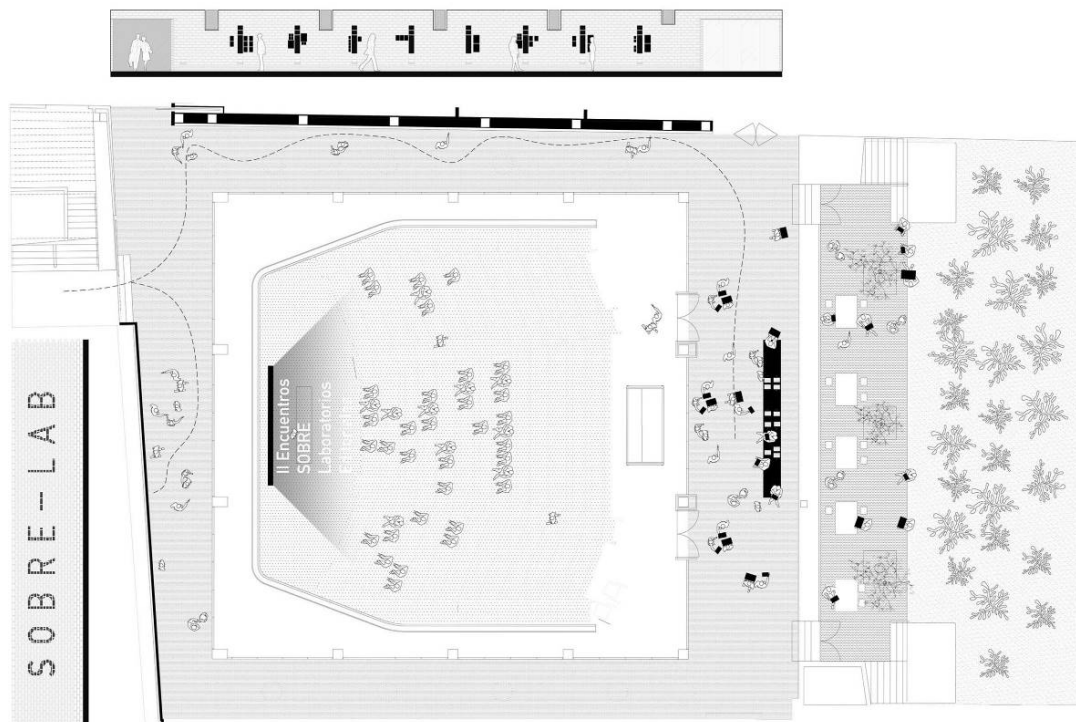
Planta y alzados del proyecto expositivo. Fuente: Alumnos y profesores del taller "Cómo exponer la edición" (2018)
